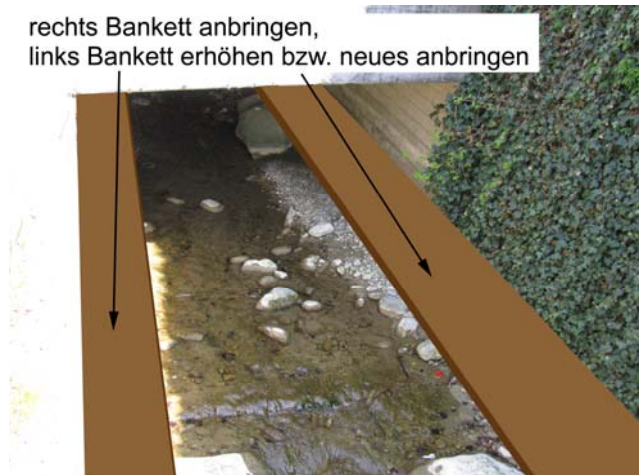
Gewässerdurchlass Lehntobelbach bei der Kantonsstrasse K48 (Massnahme GD3)
